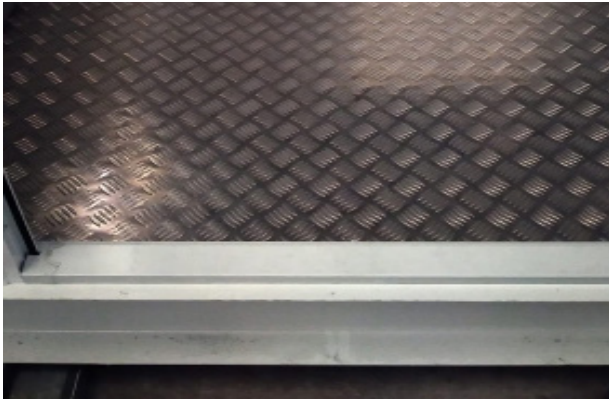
Acabado optativo de pavimento formado por chapa metálica antideslizante del módulo de Cimpra. Fuente: Elaboración propia.
